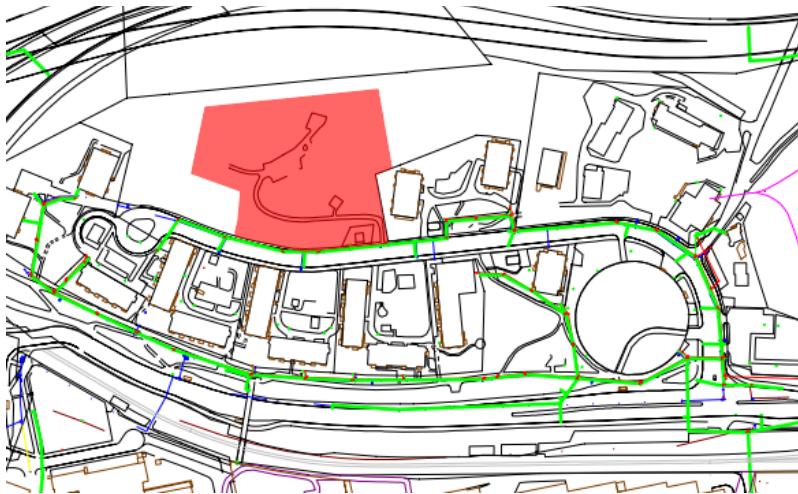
Illustration för utbyggnadsplaner på ortofoto över planområdet.
